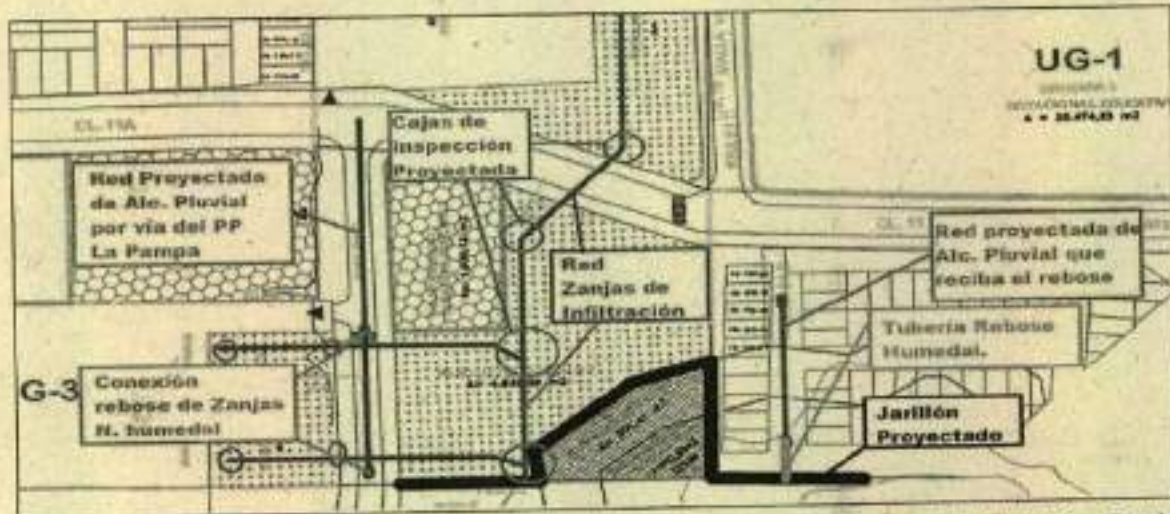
Esquema Final de la Alternativa de Solución planteada en la etapa de Factibilidad del Plan Parcial La Pampa
